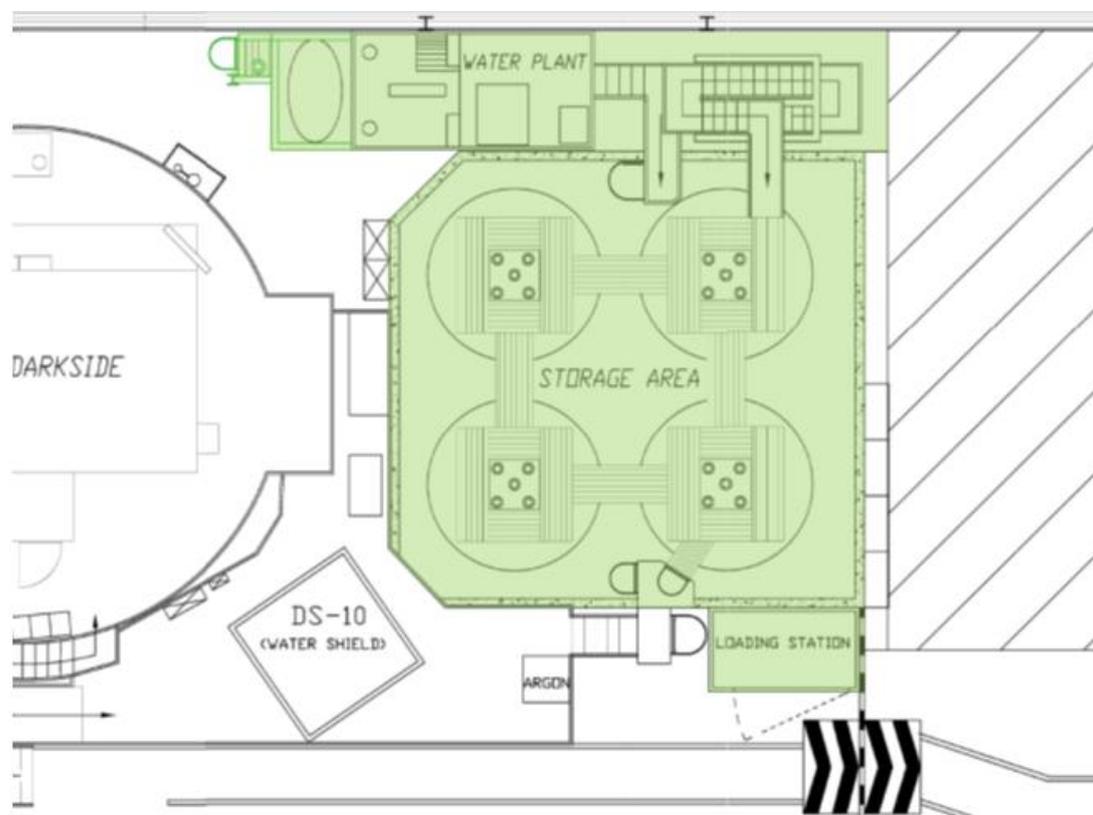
Storage Area e Water Plant (LNGS-C-SA)
